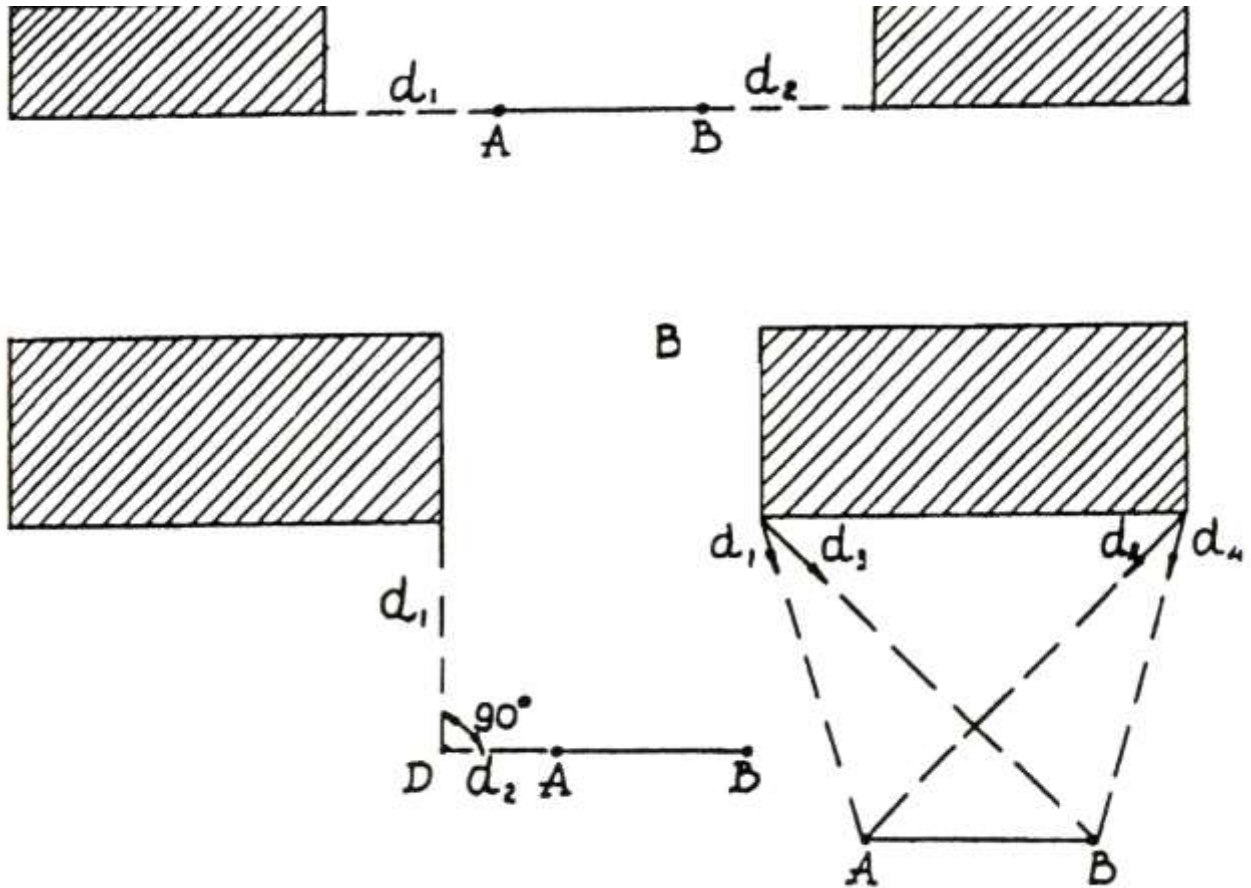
Схема перенесения в натуру осей здания от строительной сетки способом створной засечки
